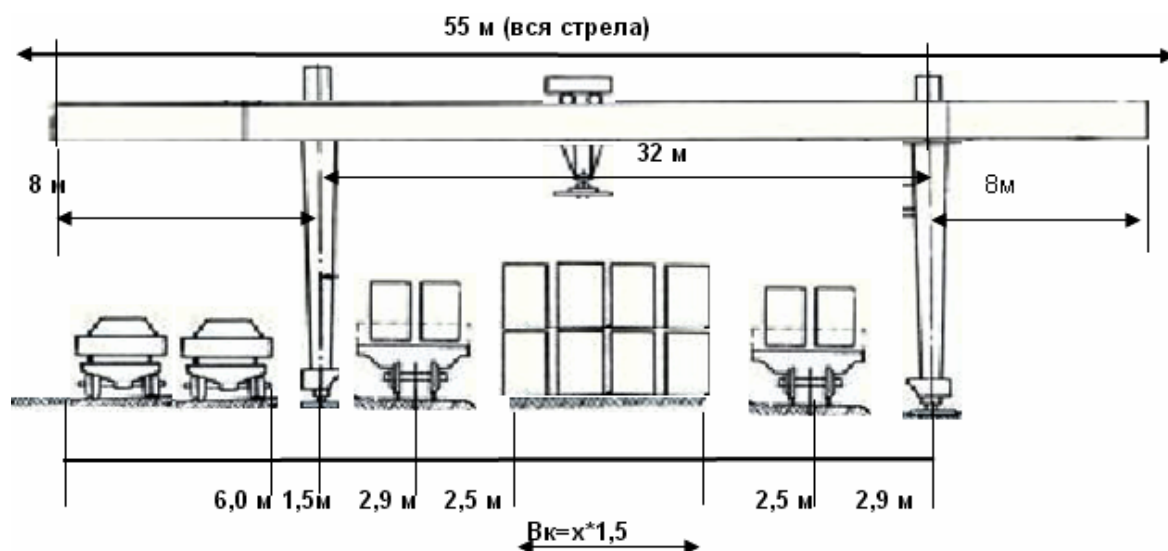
Схема контейнерной площадки (поперечный разрез)
